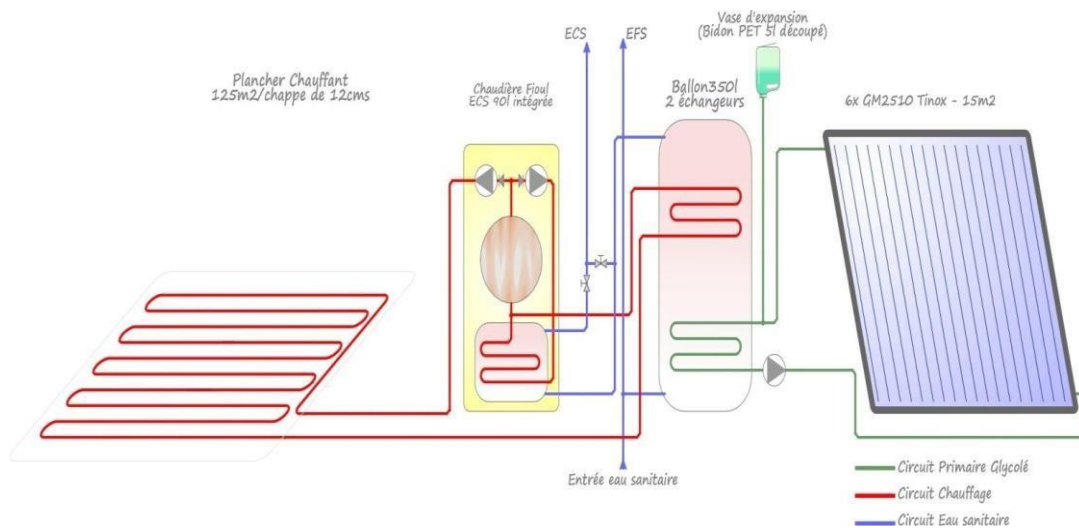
schéma d'une installation d'un plancher solaire direct [58]
